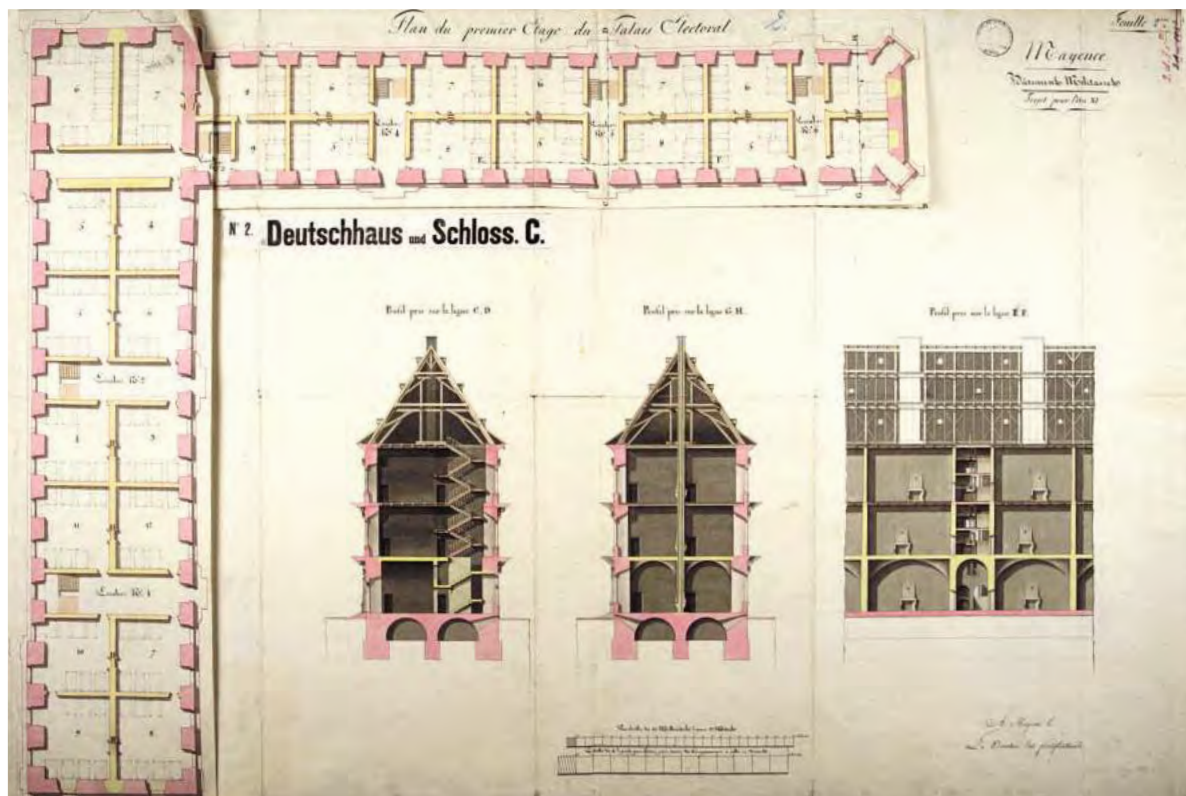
Grundriss des 1. Obergeschosses mit geplanten Änderungen zur Einrichtung des Zollmagazins, 1803.
